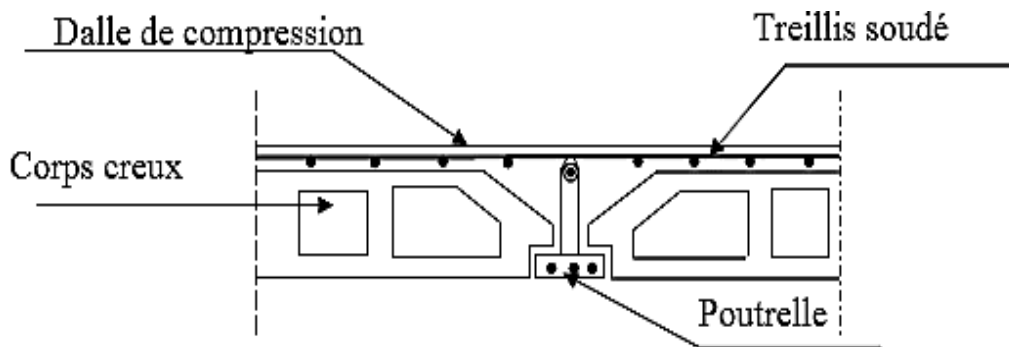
Coupe transversale dans un plancher en corps creux.
